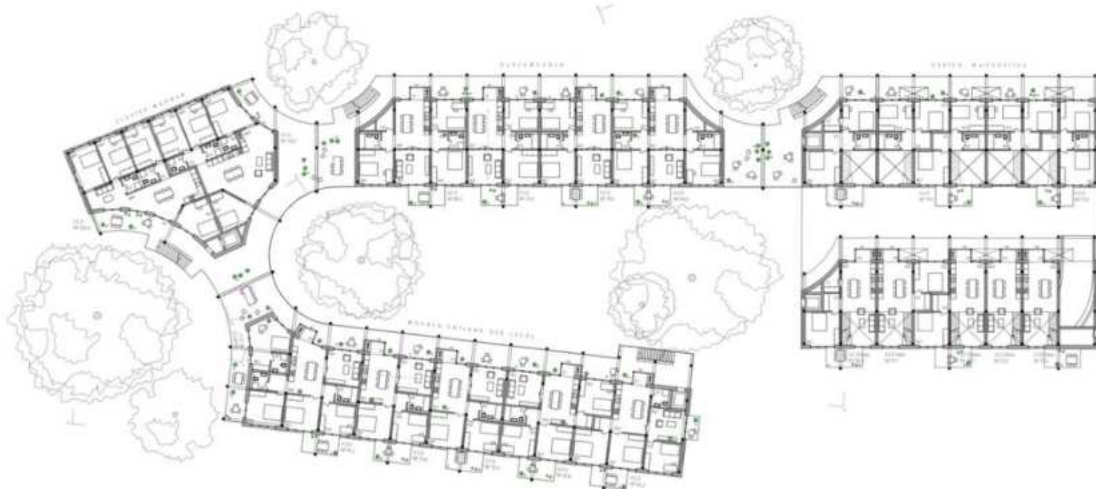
Dachaufsicht mit Umgebung, Maientanz
